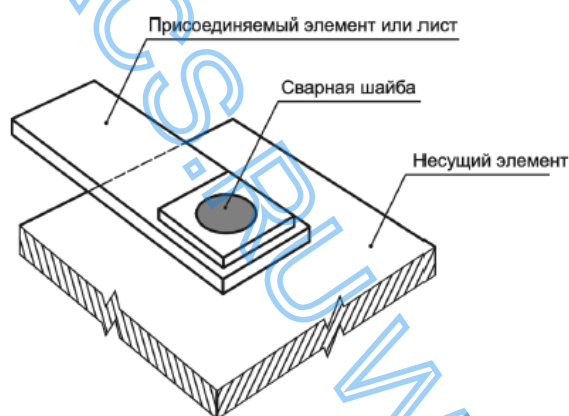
Дуговая точечная сварка со сварной шайбой
